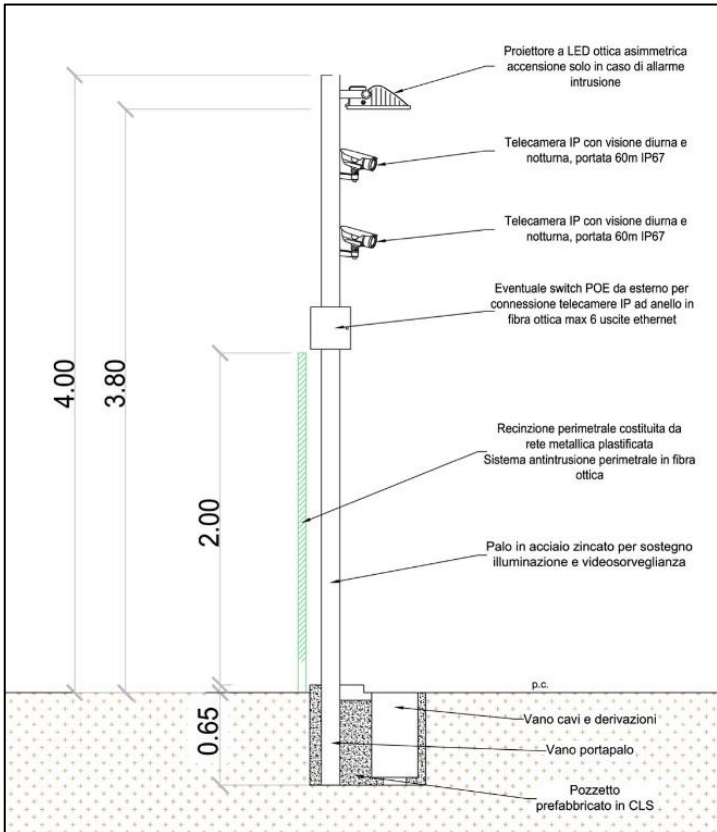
Particolare dei pali previsti per illuminazione e videosorveglianza con fondazione prefabbricata a pozzetto.
